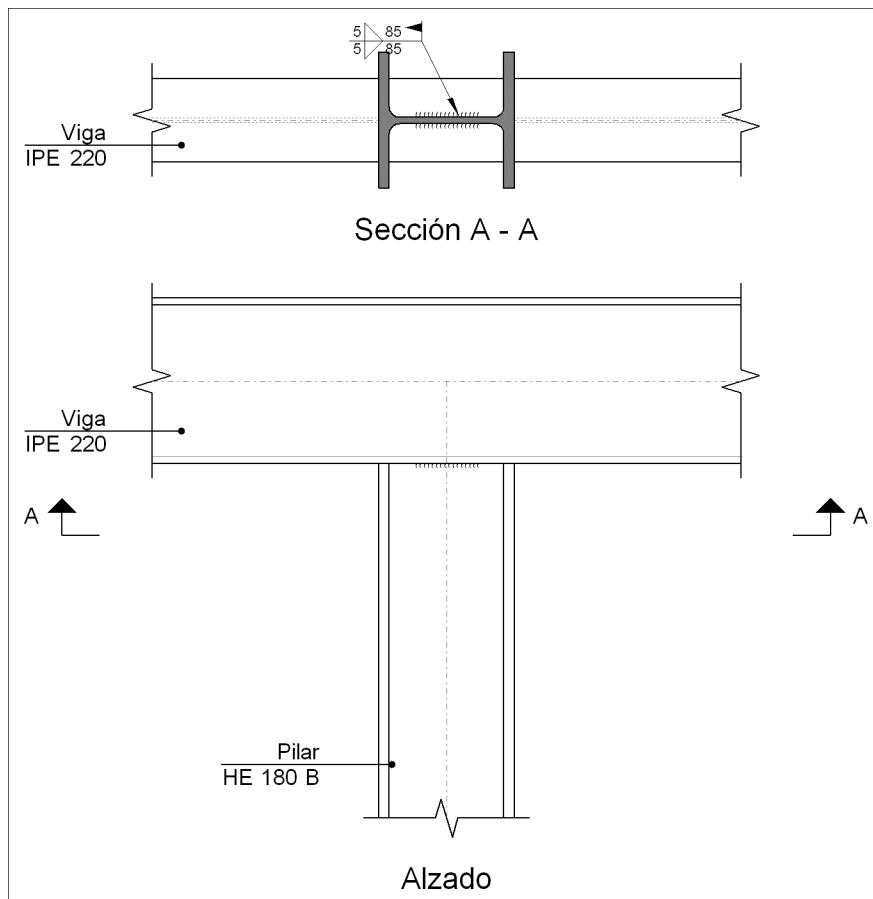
Detalle de las soldaduras tipo 5 del soporte superior
